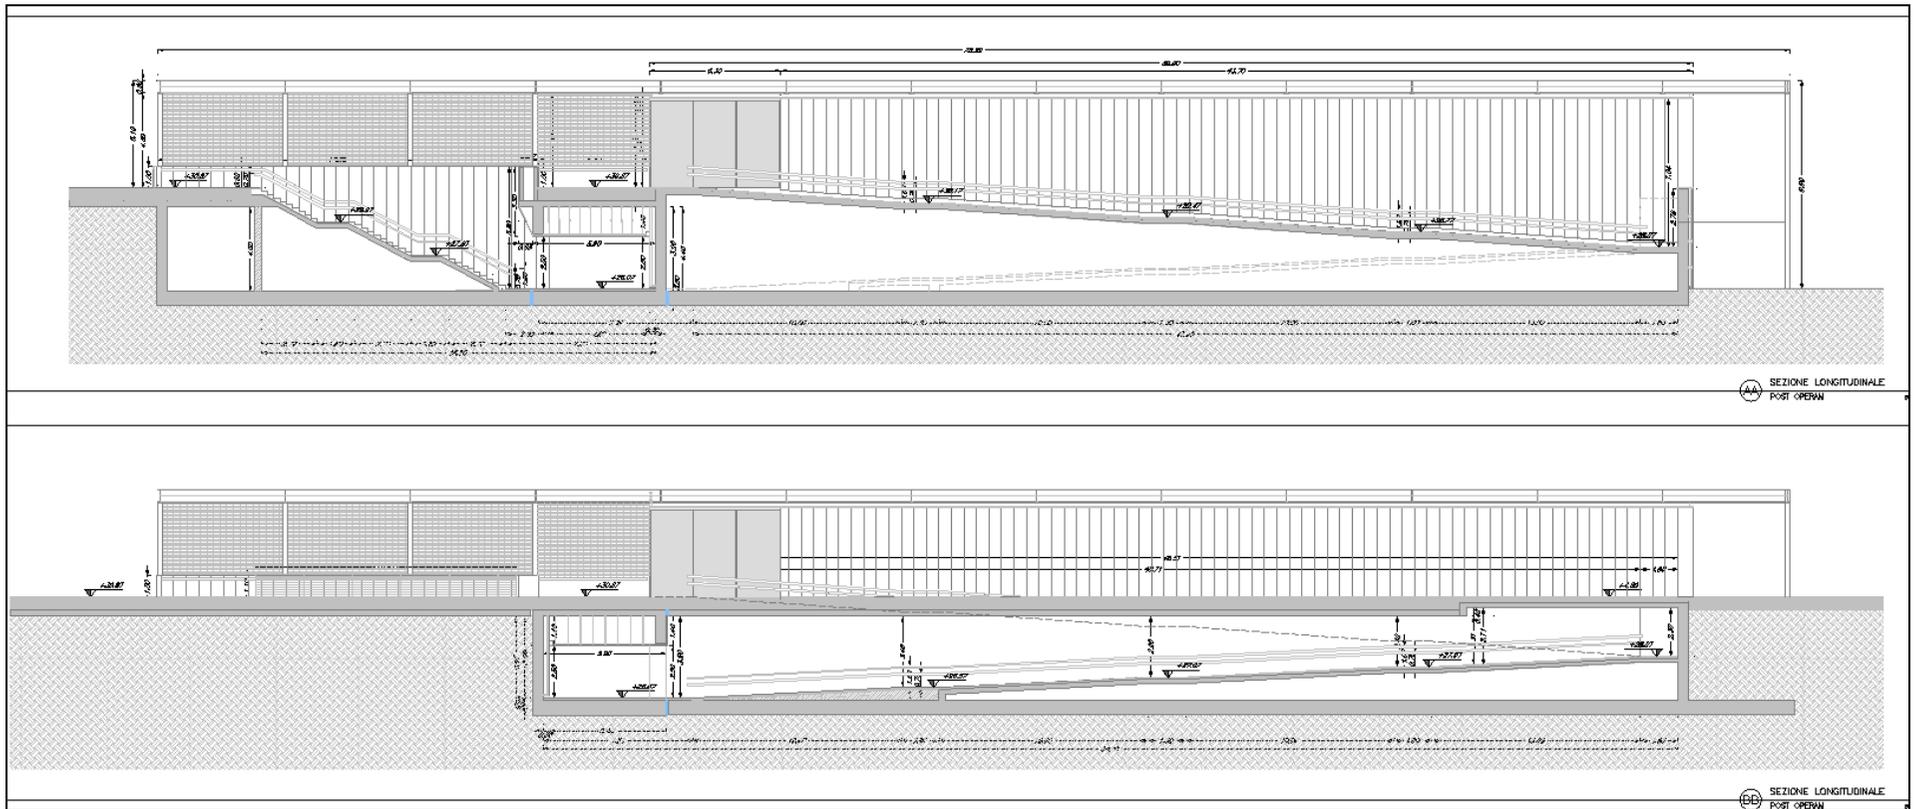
Sezione longitudinale Stazione di Acerra (rif. All. [43])
